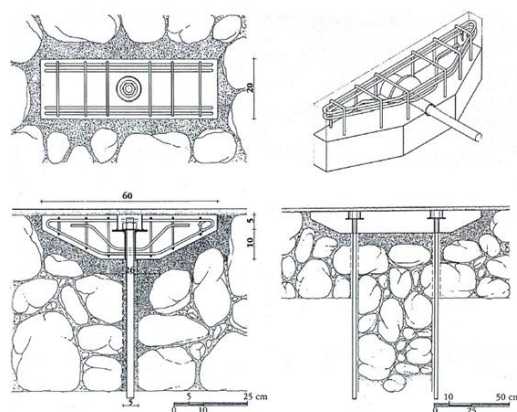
Exemplos de ancoragens retas realizadas em betão armado pré-fabricado. [5]
